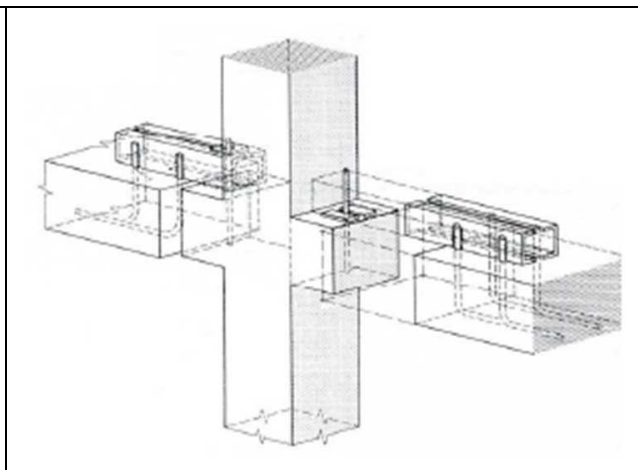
Ligação por consola curta de betão/aço com armaduras em gancho (Stupré, 1981)
